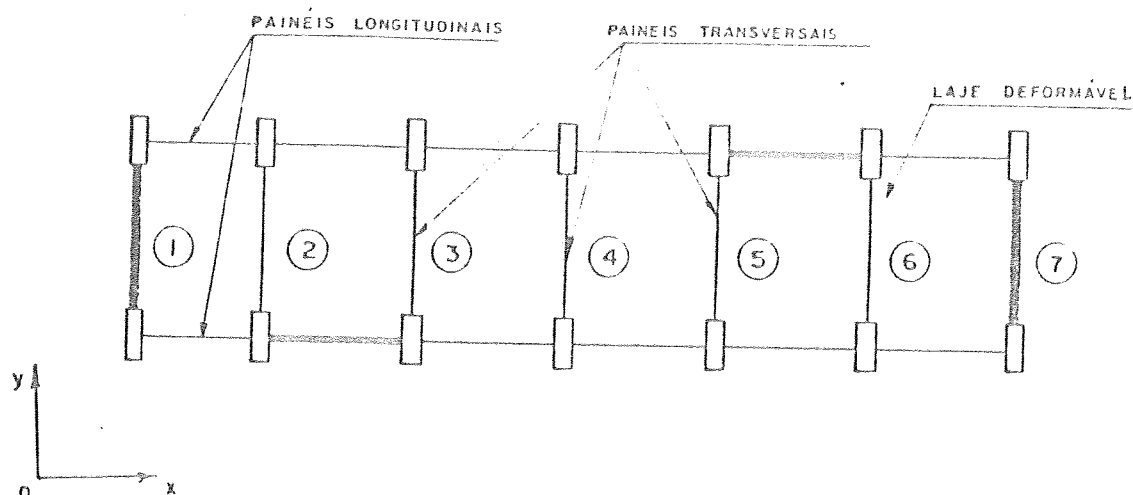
Planta de um edifício constituído de painéis transversais e lajes deformáveis em seu próprio plano.
